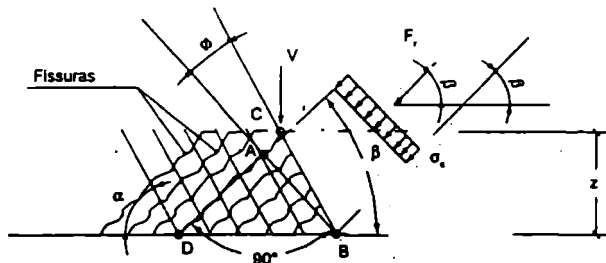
Tensões de compressão nas bielas de concreto em uma viga fletida.
